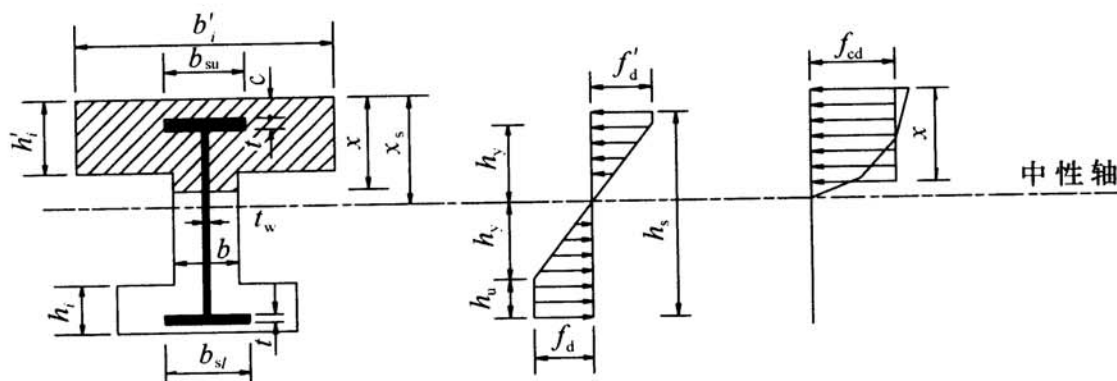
中性轴位于混凝土腹板中的截面抗弯计算图式
